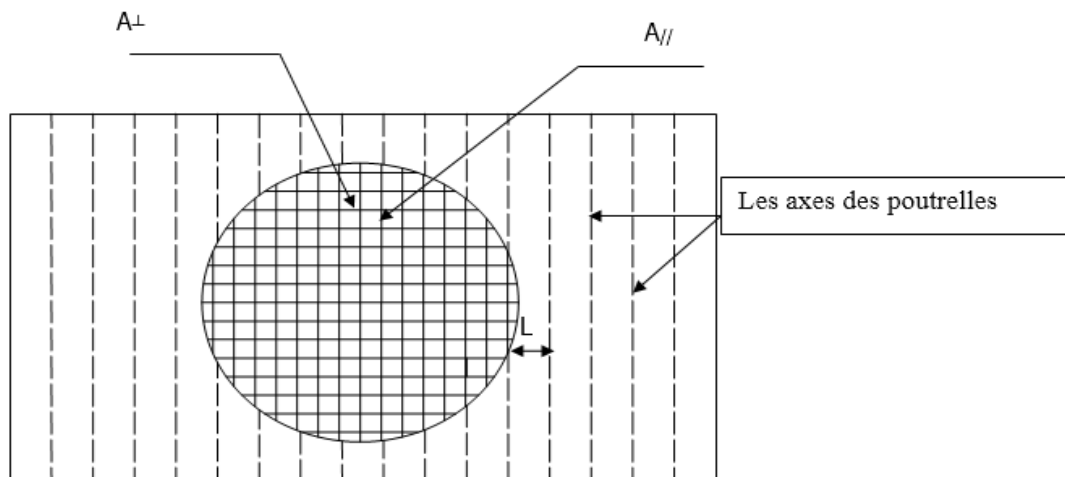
Dessin de ferrailage des poutrelles.
